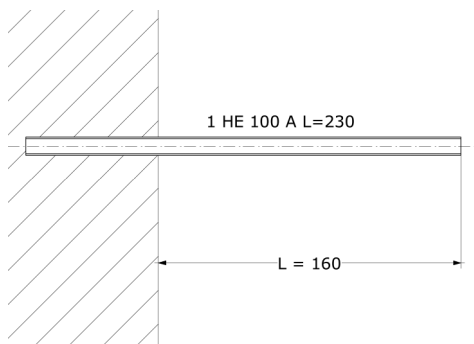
Trave in acciaio di una copertura a sbalzo
